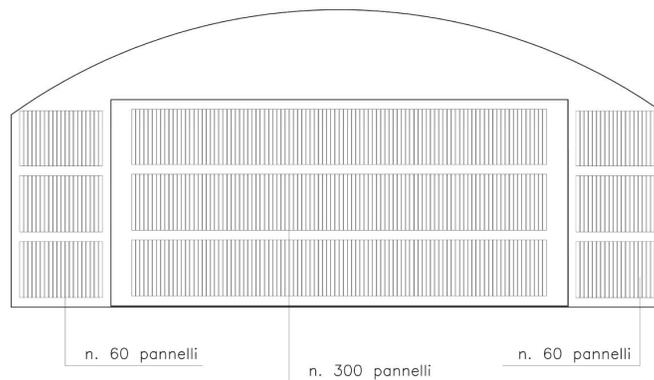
Caratteristiche di disposizione dell'impianto fotovoltaico ai fini del rispetto delle disposizioni di cui all'art.11 D.Lgs n.28/2011.
